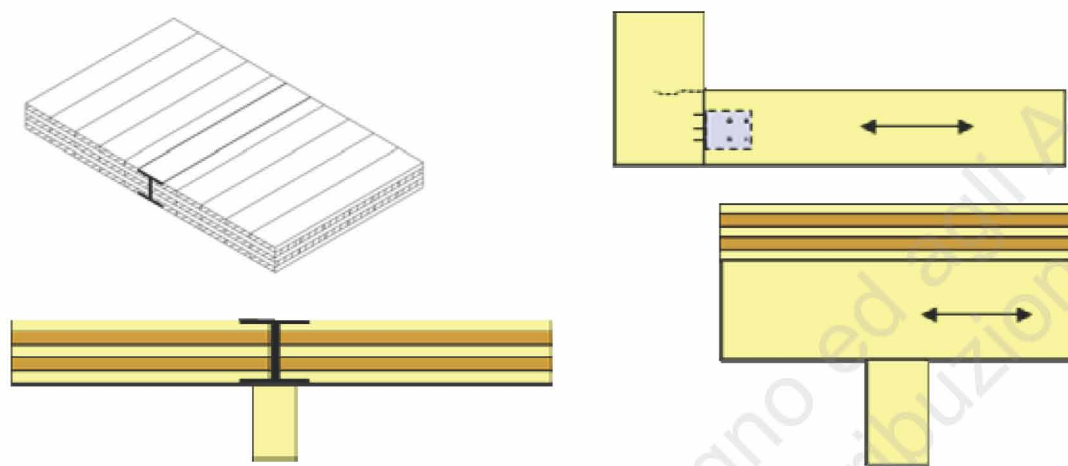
Alcuni particolari costruttivi dei collegamenti pilastro-trave-solaio
